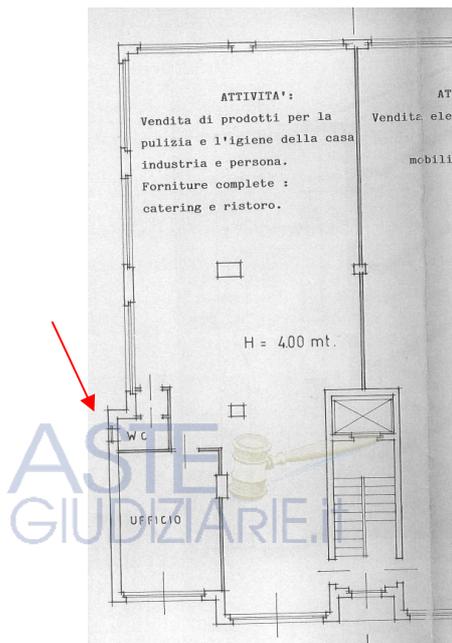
Estratto planimetria Autorizzazione n.1776/1991
